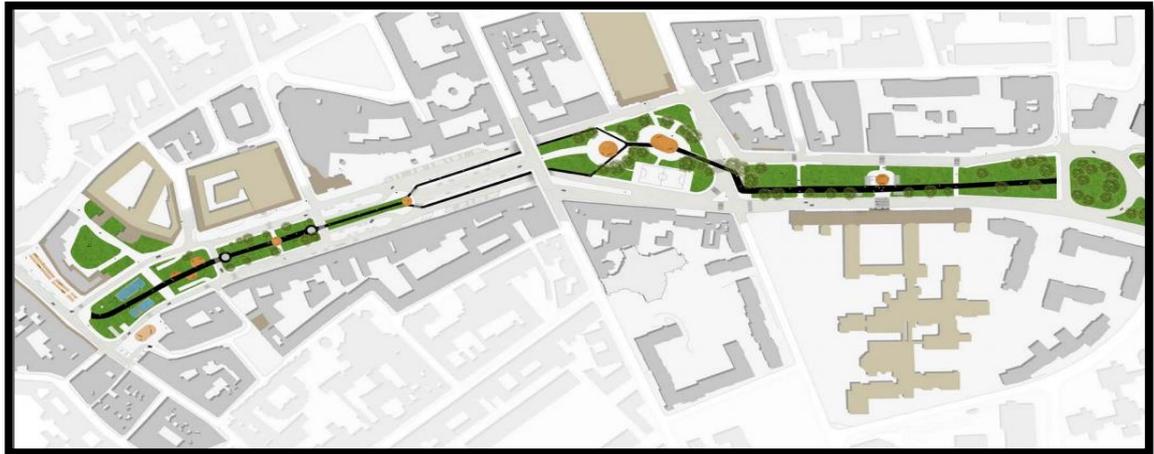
Plan de masse de l'avenue peuple belge après sa requalification
